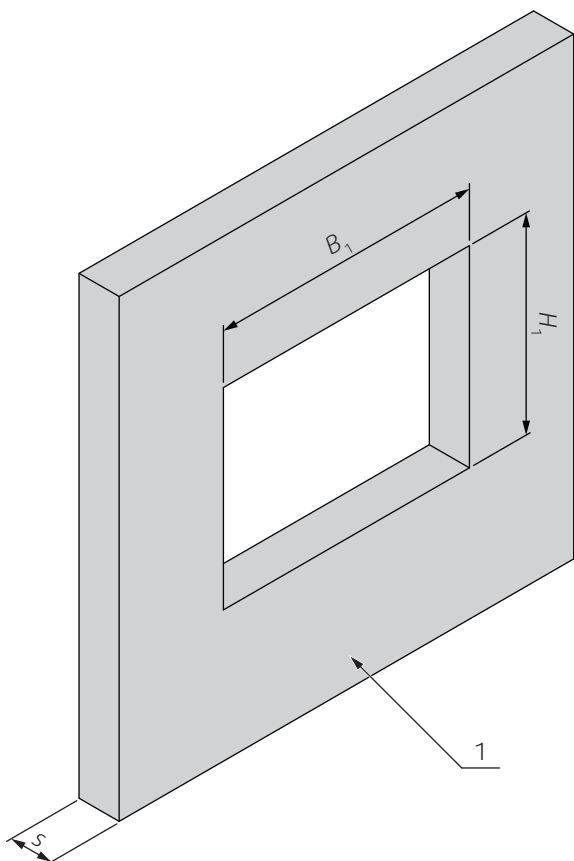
Massiv Wand-/Deckenkonstruktion mit rechteckiger Öffnung
